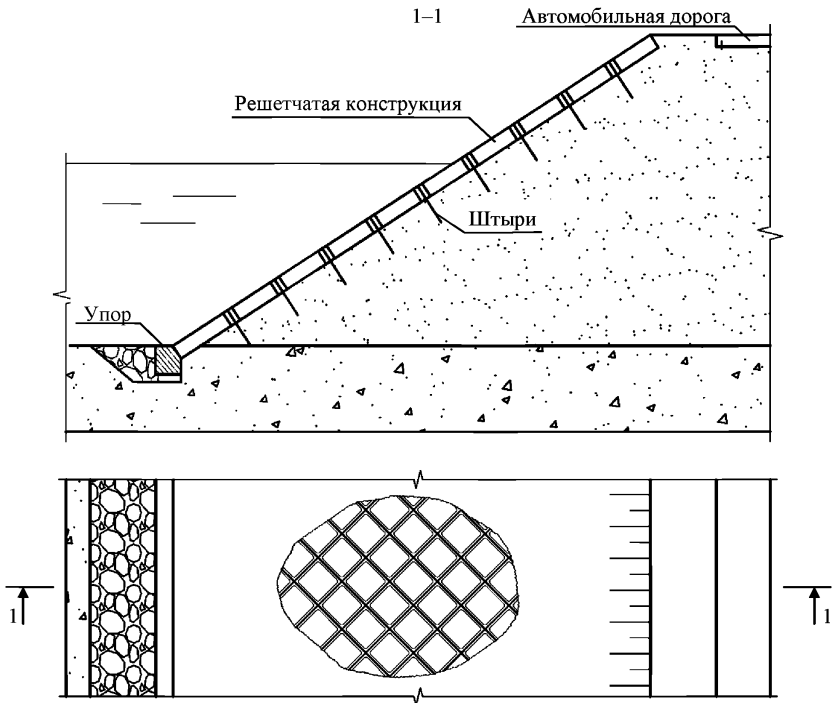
Решетчатая конструкция покрытия из сборных железобетонных элементов
